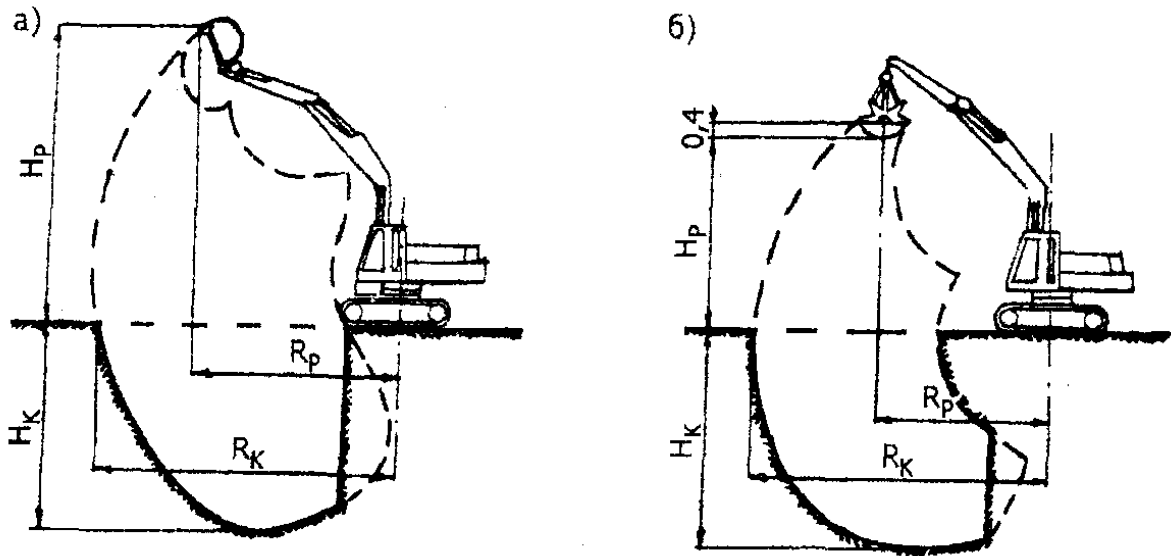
Схема рабочих параметров экскаватора: а - обратная лопата; б - грейфер:
